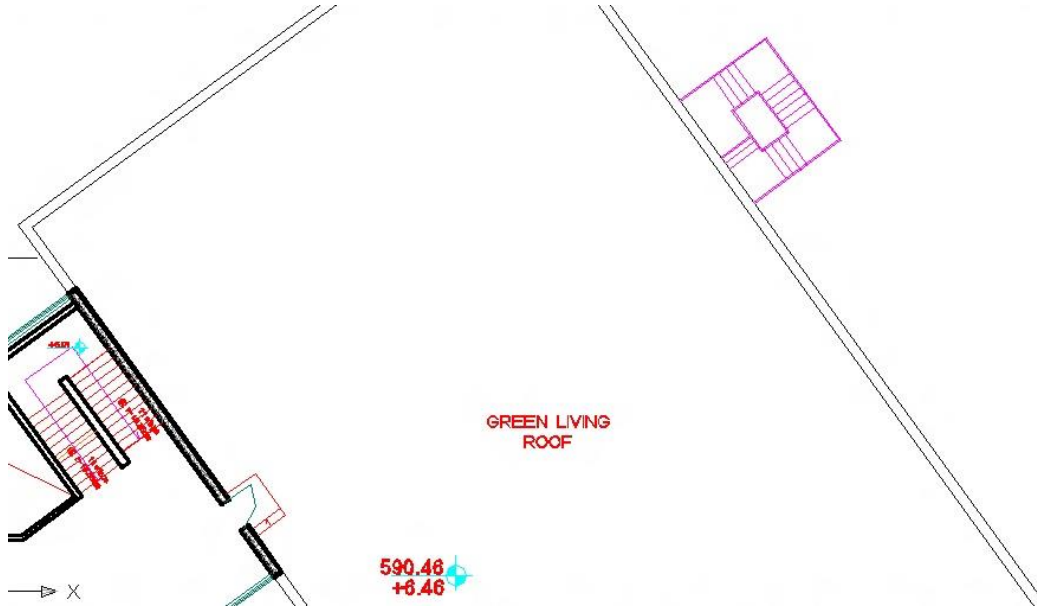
مسقط الطابق الاول الجزء الرابع.
